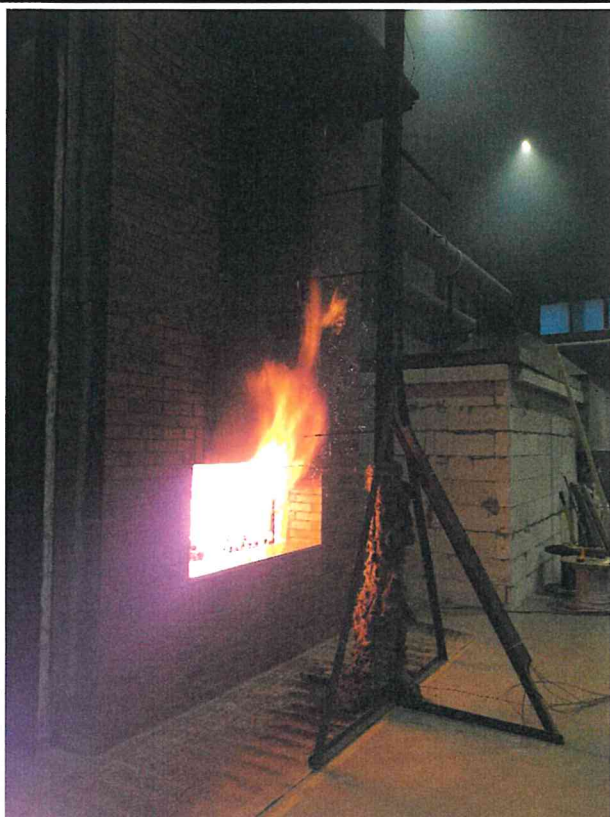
Внешний вид образца на 15-й минуте испытания.
